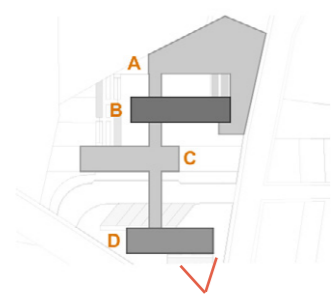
Relación estructura-fachada A1 || Fuente: Elaboración propia
